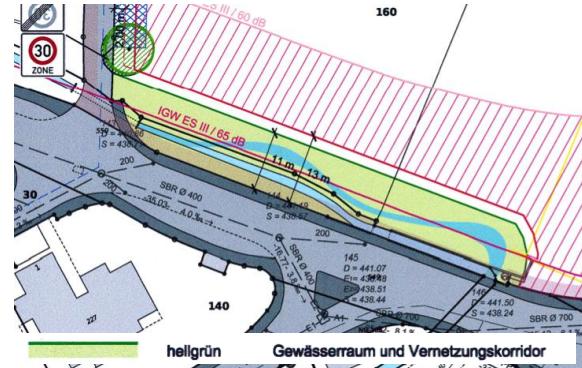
Renaturierung Dorfbach. Quelle: Ausschnitt Erschliessungsplan Im Labi. 04.03.2015
